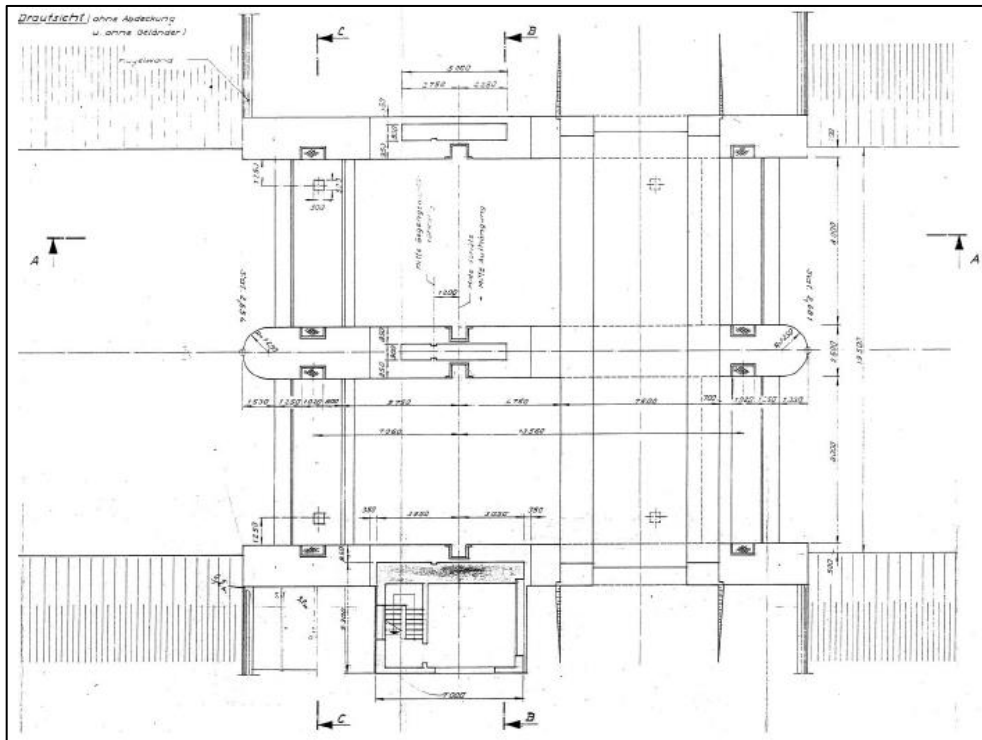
Grundriss Sudeabschlussbauwerk
